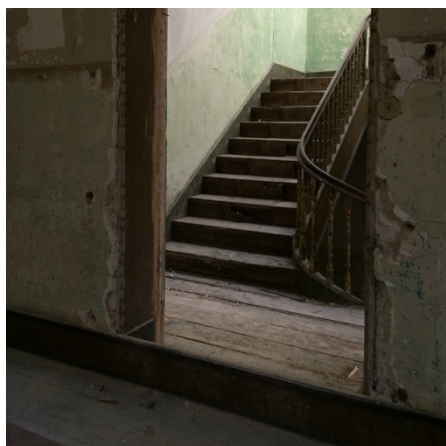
Estado do pavimento das circulações horizontais comuns, piso 1.
